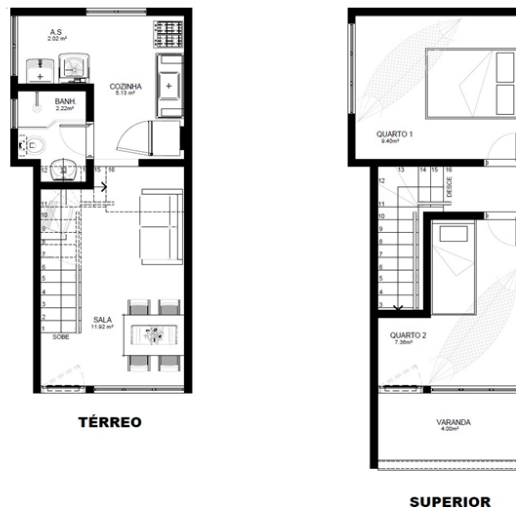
Planta-baixa Tipo D. Fonte: Aflalo (2016)
